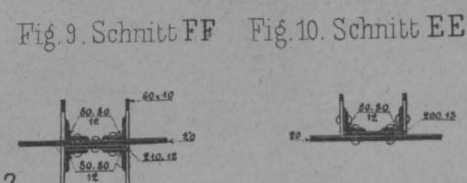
Schnitt FF Fig. 10. Schnitt EE
